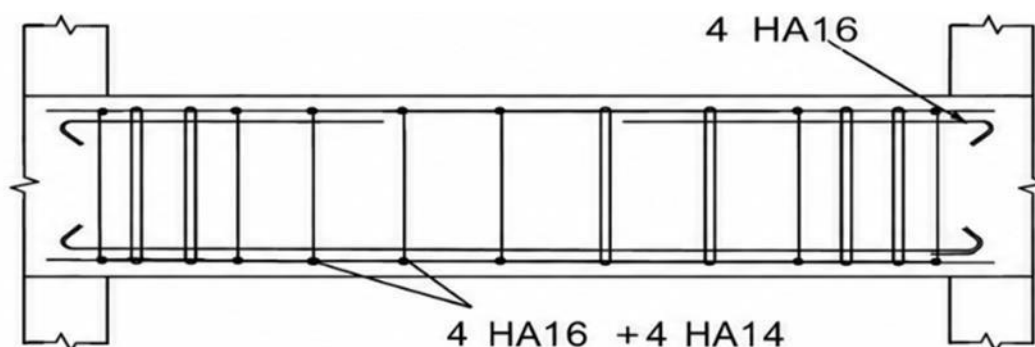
Vue d'élévation de la poutre (P2).
